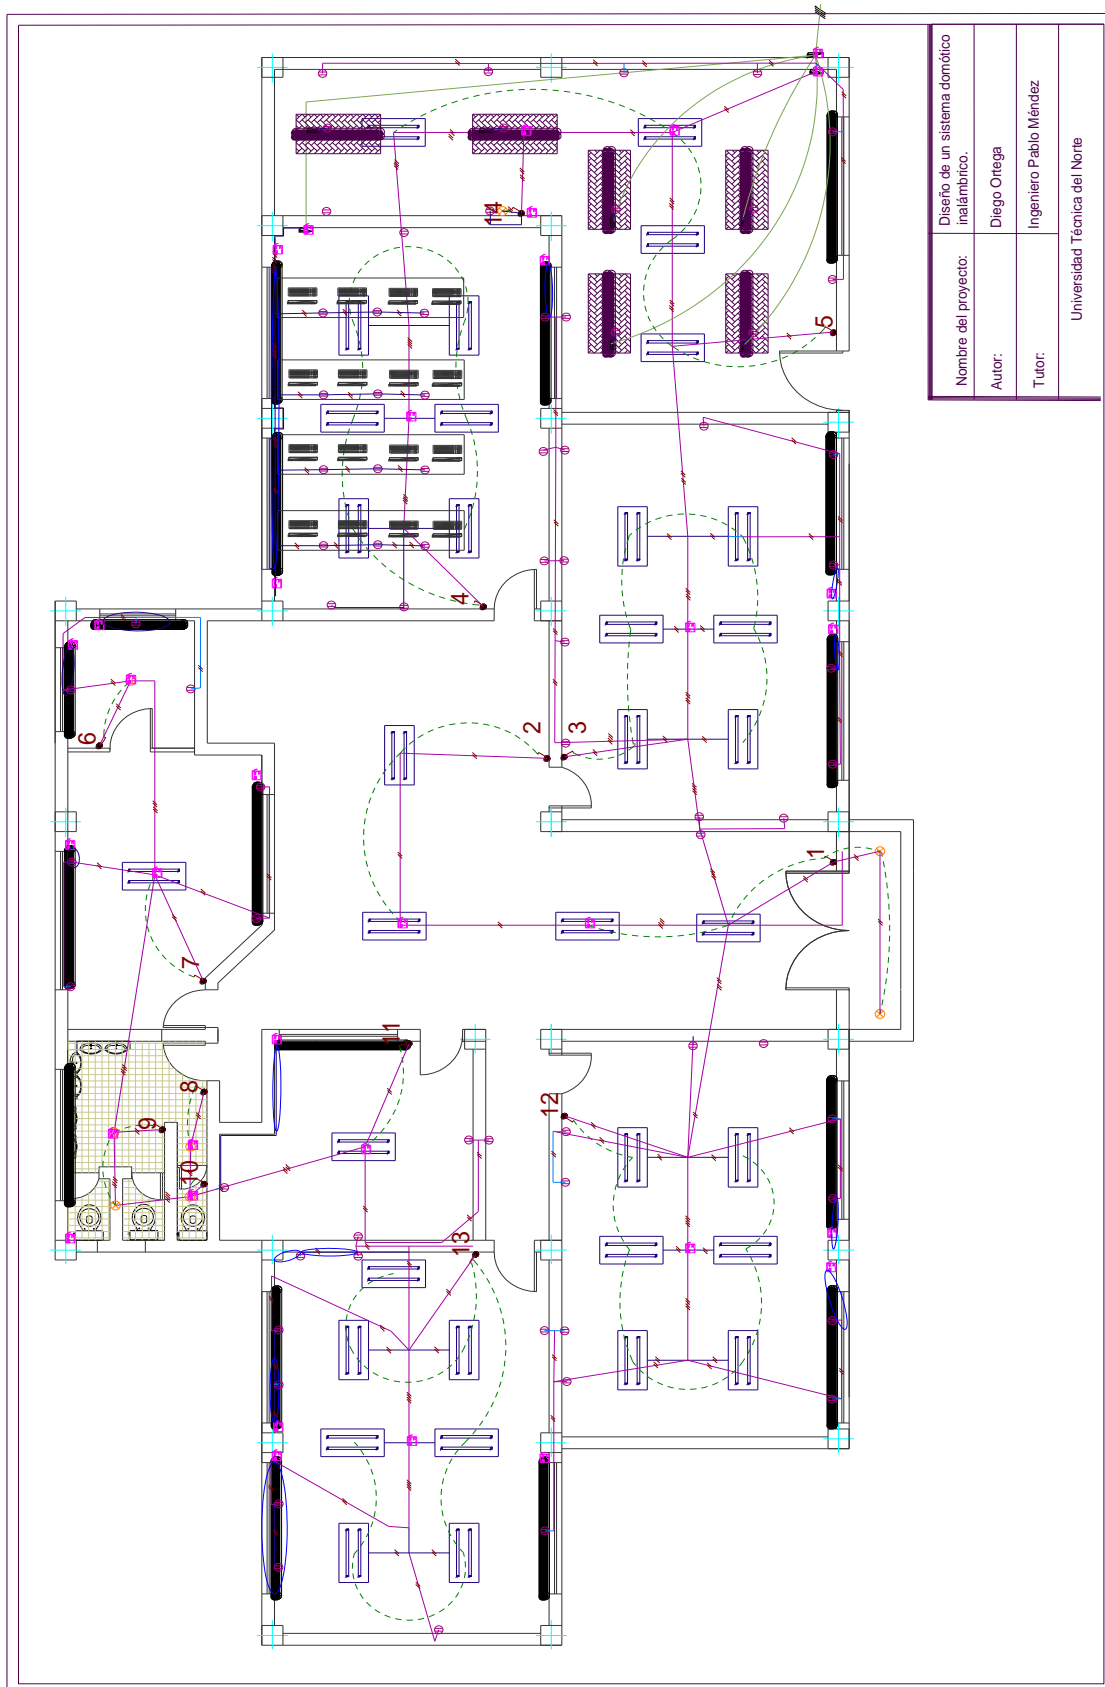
Diseño eléctrico acoplado al plano ya existente.
